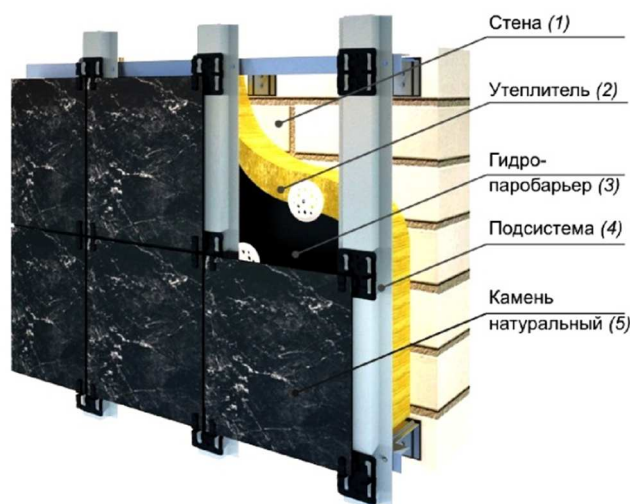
Слои конструкции навесного вентилируемого фасада
